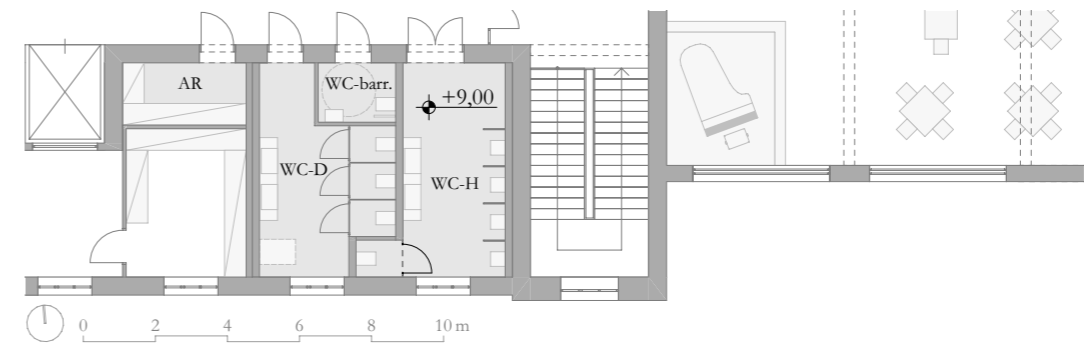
Grundriss Dachgeschoss (Sanitärbereiche und Abstellraum) M 1:200
